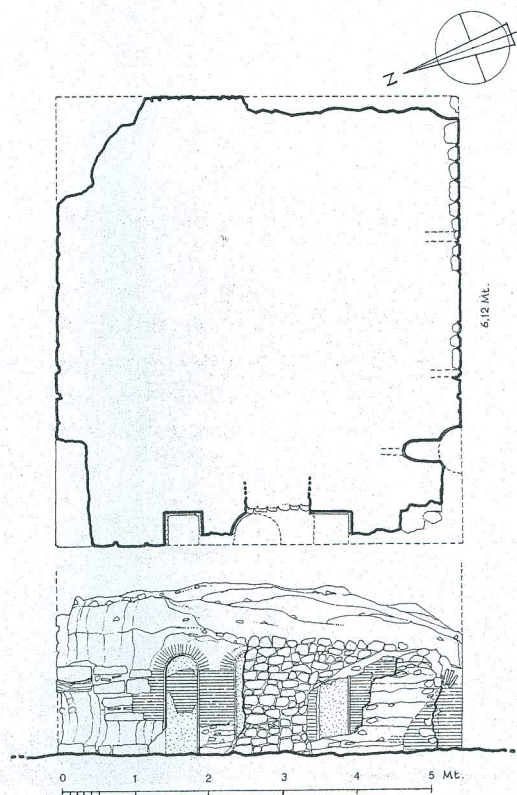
PIANTE E PROSPETTO OVEST DELLA FONTANA BIZANTINA N. 36.
